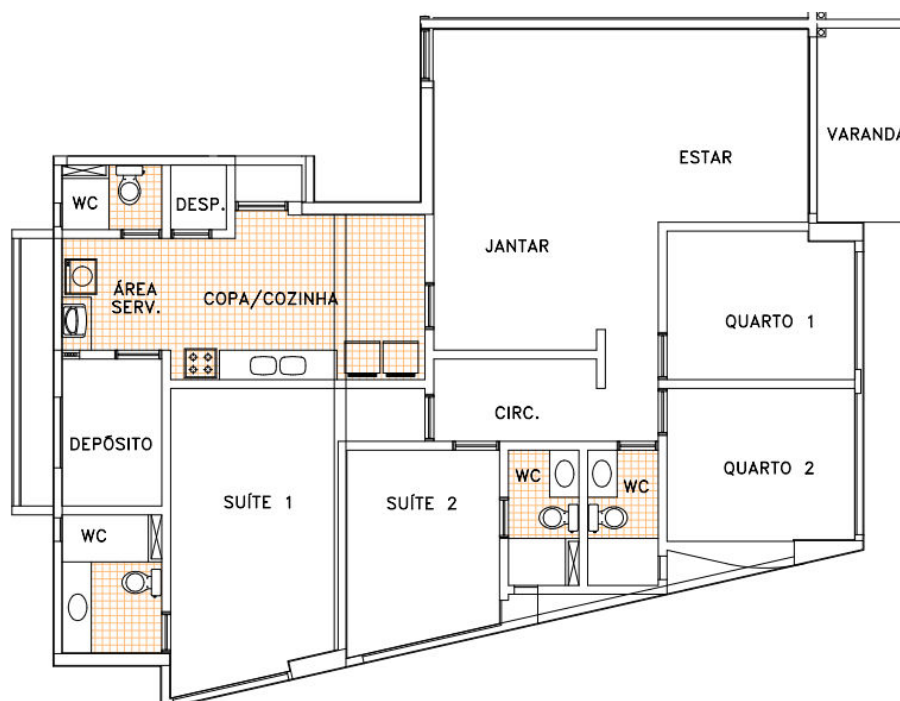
Planta baixa do edifício ensaiado no caso 1 (Site da construtora)
